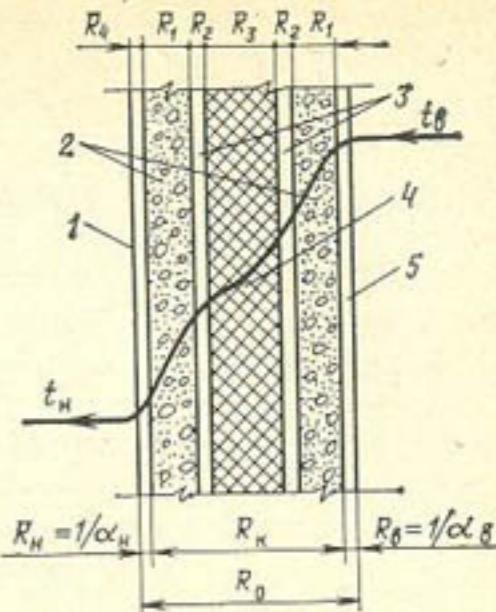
Расчетная схема перемещения теплового потока в трехслойной наружной стене:
